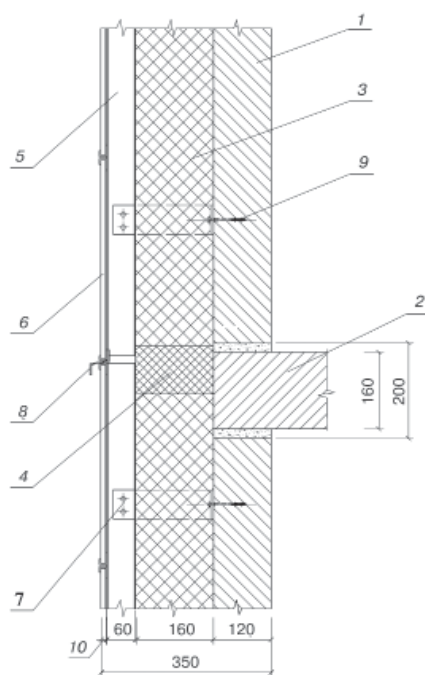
Горизонтальный стык панелей наружных стен с НФС ВВЗ: 1 – железобетонная панель; 2 – железобетонная плита перекрытия; 3 – утеплитель; 4 – упругая минераловатная вставка; 5 – вертикальный профиль; 6 – облицовочная плитка; 7 – кронштейн; 8 – козырек; 9 – дюбель кронштейна
